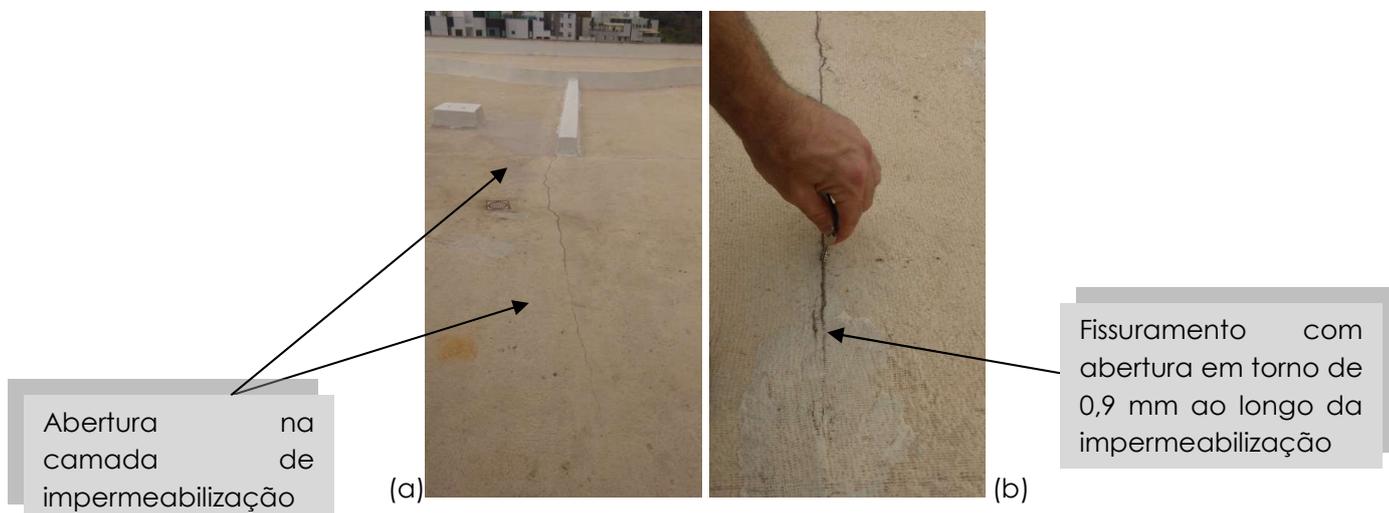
a e b- aberturas causada por fissuras e trincas ao longo da laje. (Fonte: os autores, 2016)
